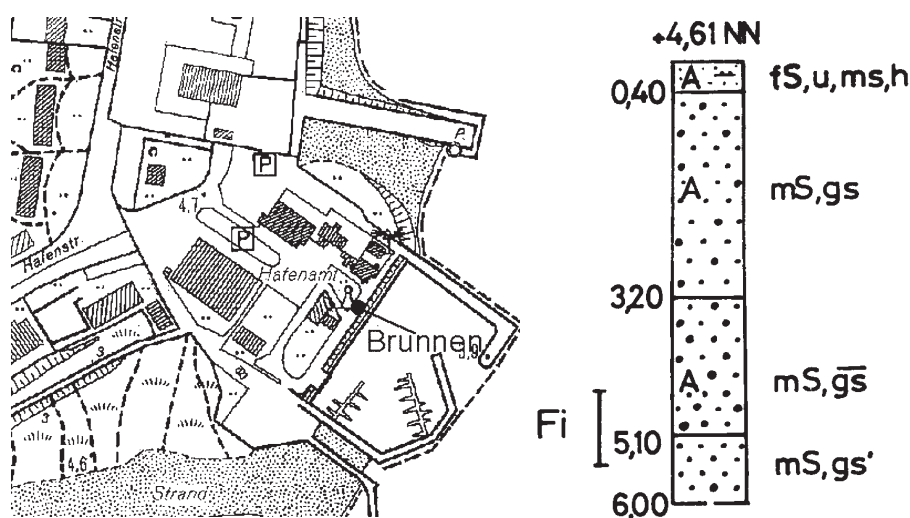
Lageplan des Hafens List/Sylt mit Bohrprofil und Lage der Filterstrecke
